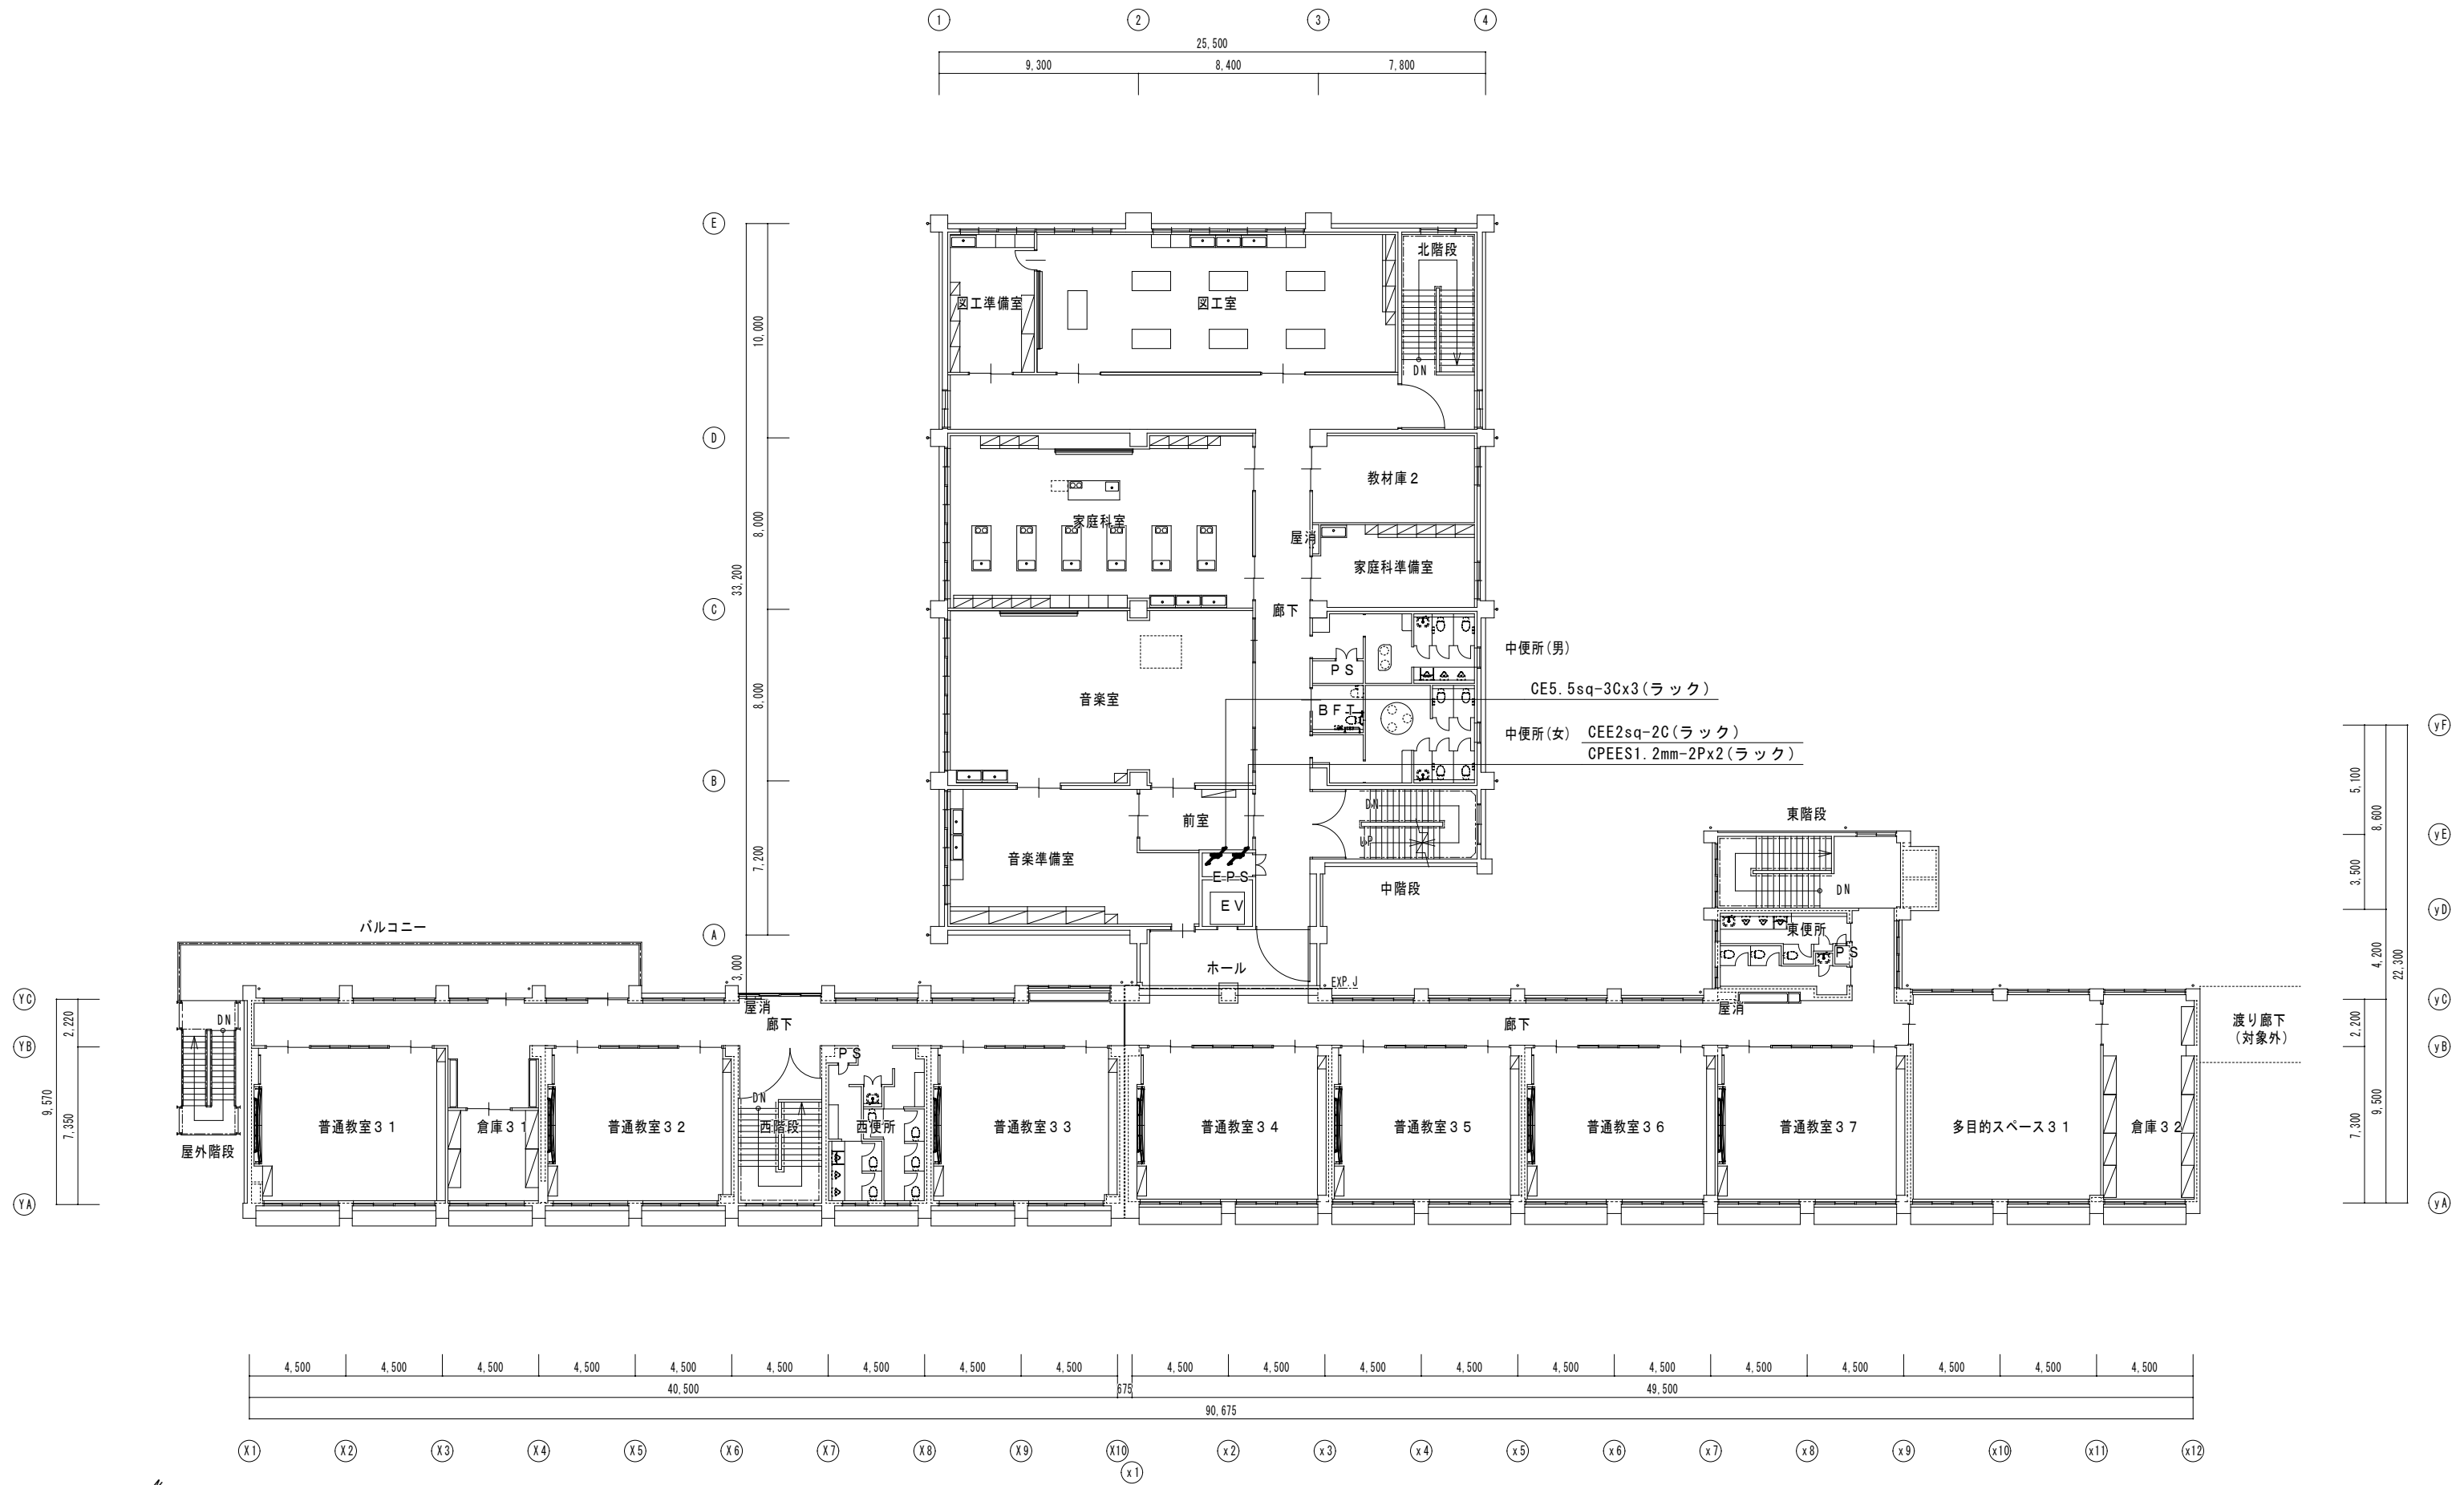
階 発電設備 (太陽光発電) 平面図 (改修後)
